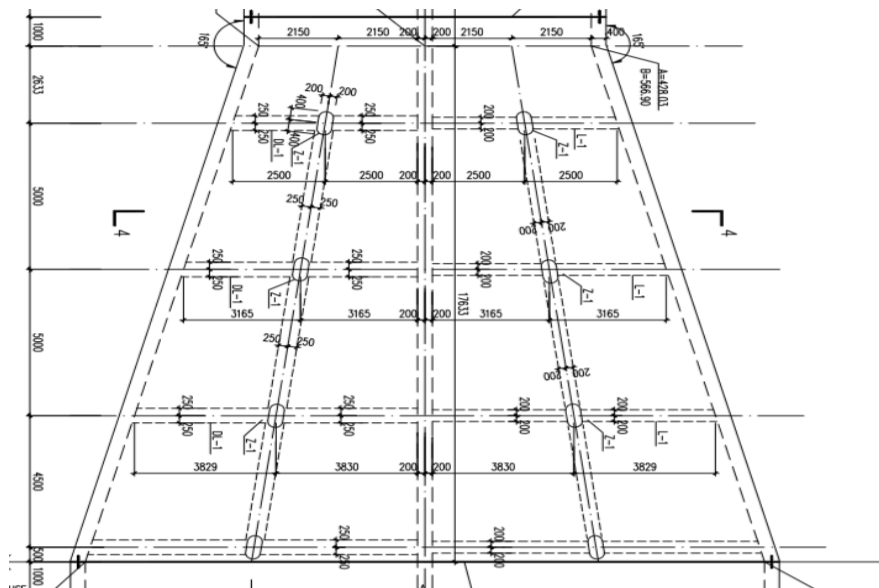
Planta do Troço-D da CCC do Soyo.
